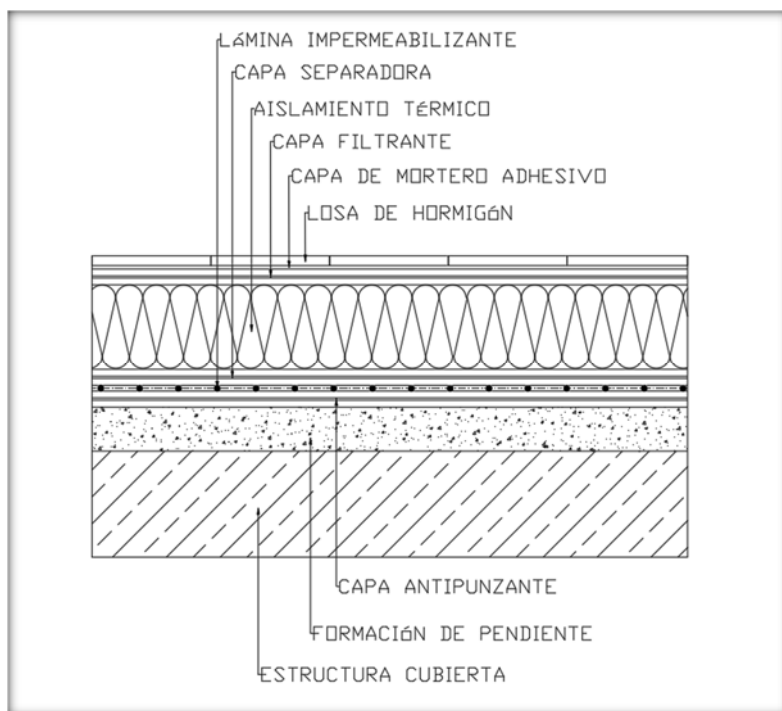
Detalle Constructivo Cubierta Plana Invertida Transitable
